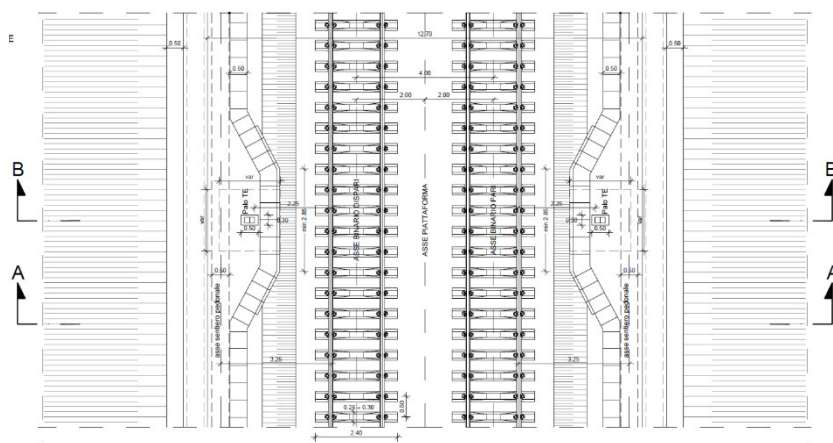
Stralcio planimetrico con sezione tipo ferroviaria in trincea a doppio binario in rettilo
